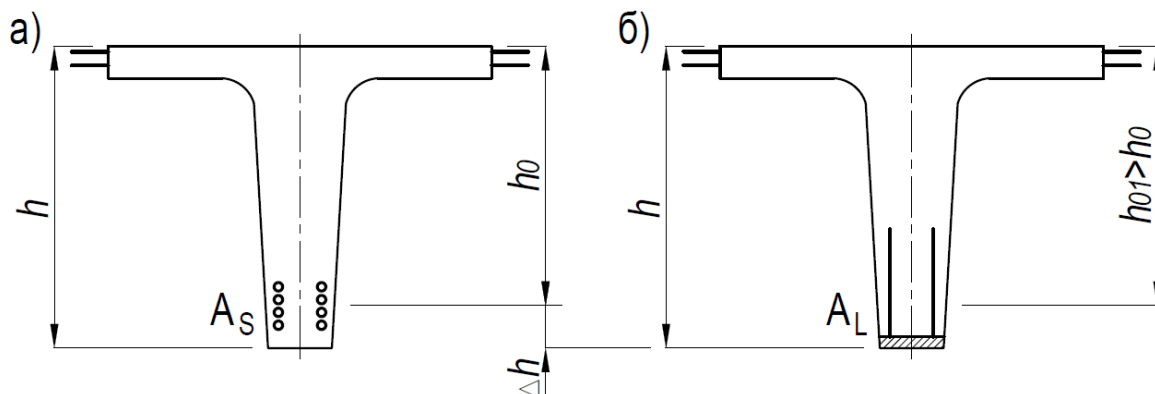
Поперечні перерізи залізобетонної (а) і сталобетонної (б) балок
